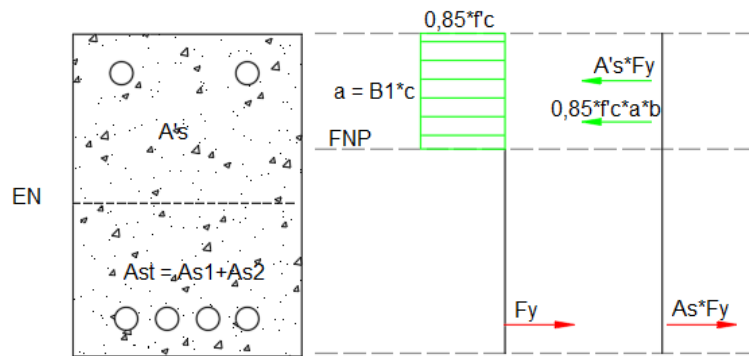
Distribución de tensiones de la viga en concreto reforzado.
